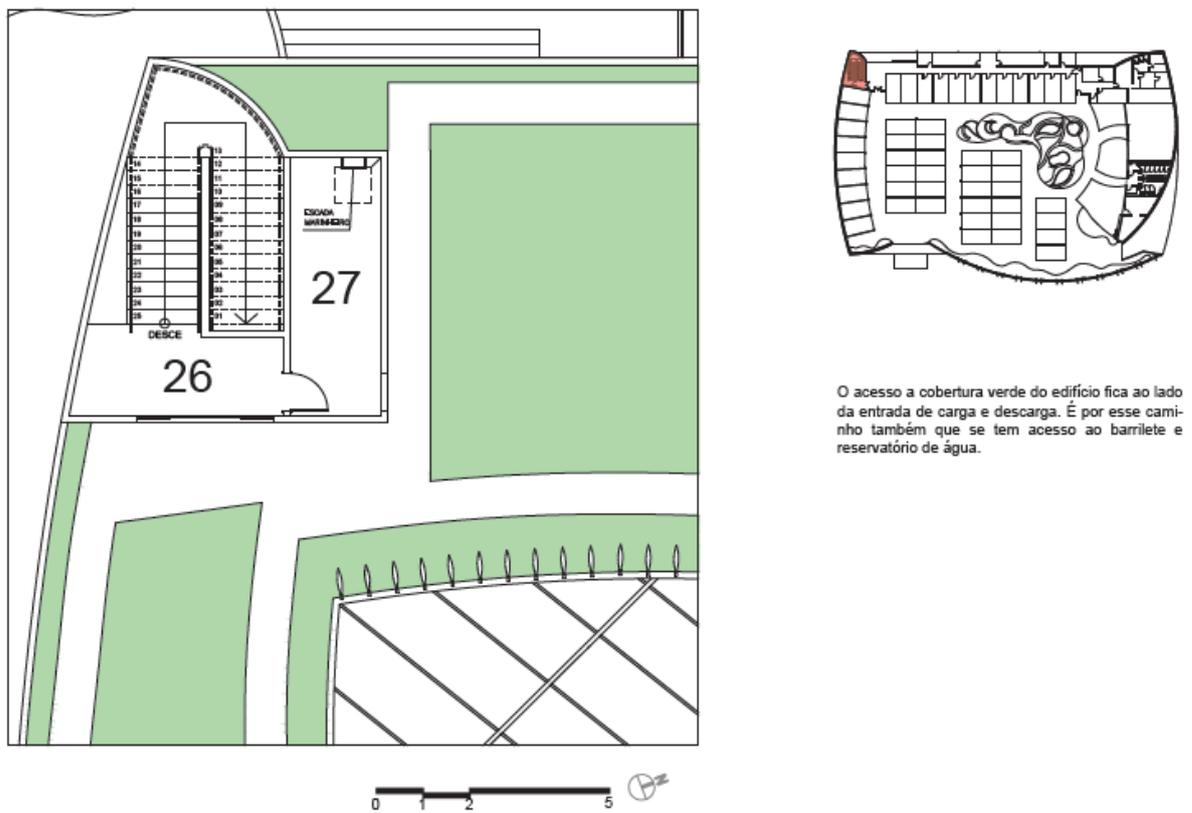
Planta Baixa (Acesso a cobertura). Fonte: Acervo do autor.
